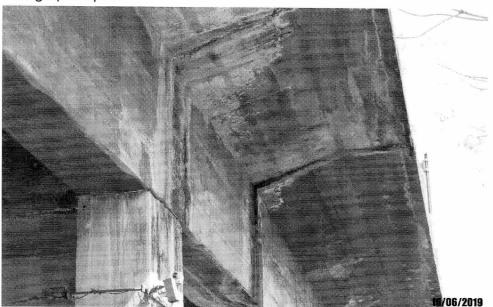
Detalhe de eflorescência na face inferior do passeio.
